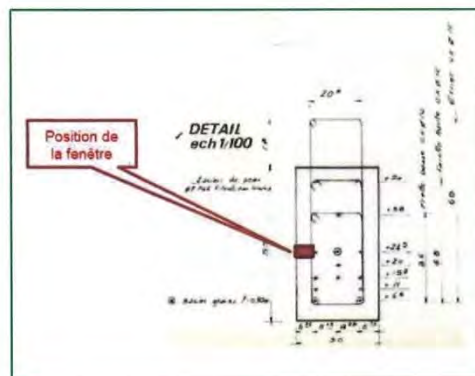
Position des fenêtres pour essai à l'Arbalète sur les poutres de rive
